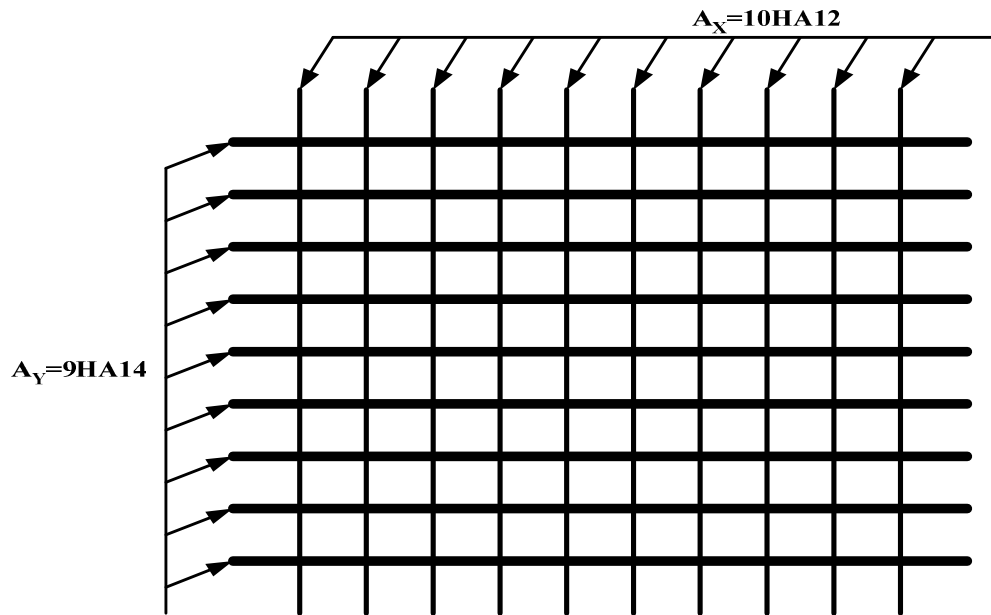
Schéma de ferrailage de la semelle isolée
